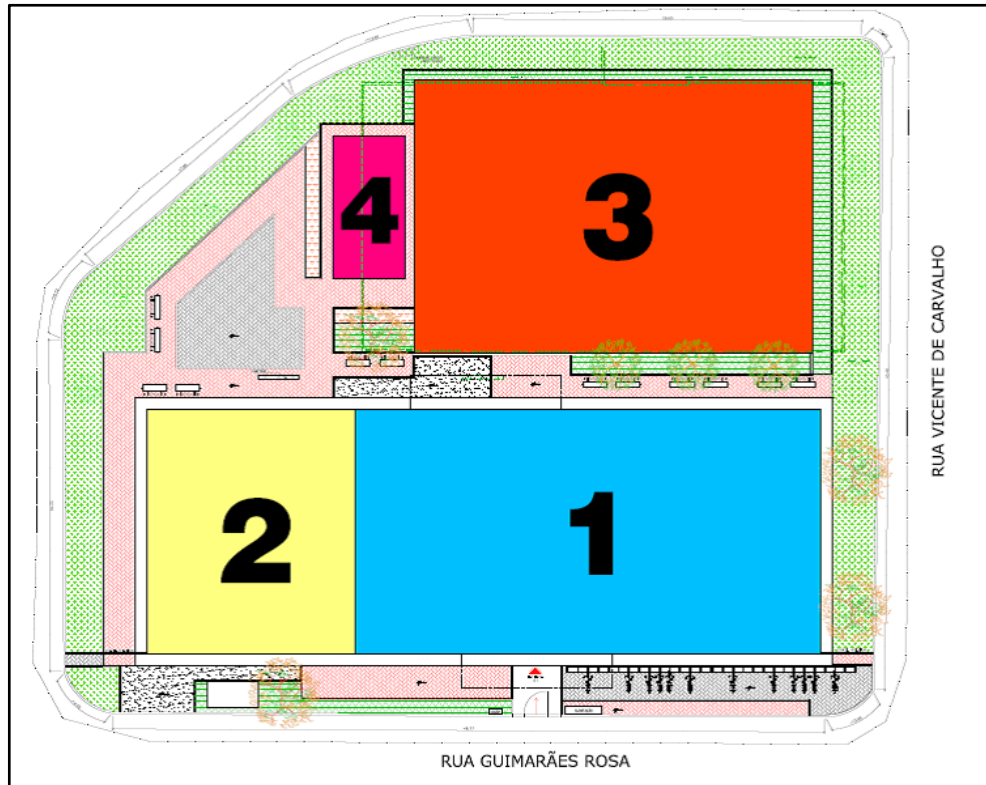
1. Edificação Existente com 2 pavimentos a ser reformada; 2. Área de ampliação com 2 pavimentos; 3. Quadra esportiva coberta a construir; 4. Castelo d’água a construir.
